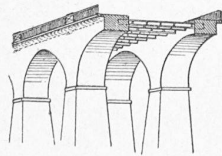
Type de pont mixte à arcs en maçonnerie et plancher métallique.
